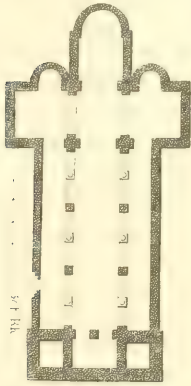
Kirche zu Hecklingen. (Grundriss.)
